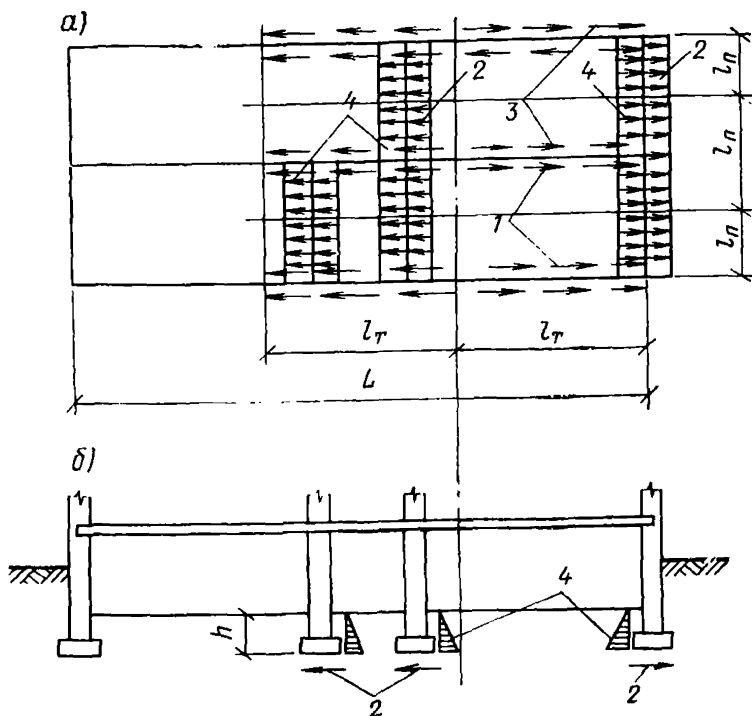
Схема сил, передающихся на фундаменты под влиянием горизонтальных перемещений грунта при просадке его от собственного веса
